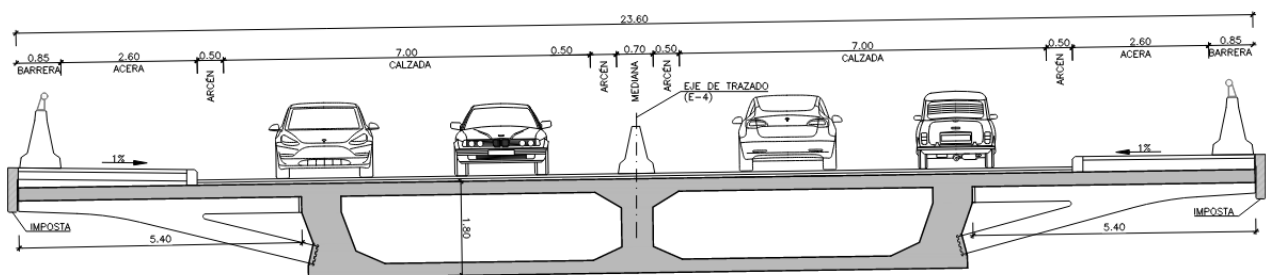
Sección transversal del viaducto en zona de ancho constante (cajón bicelular).
